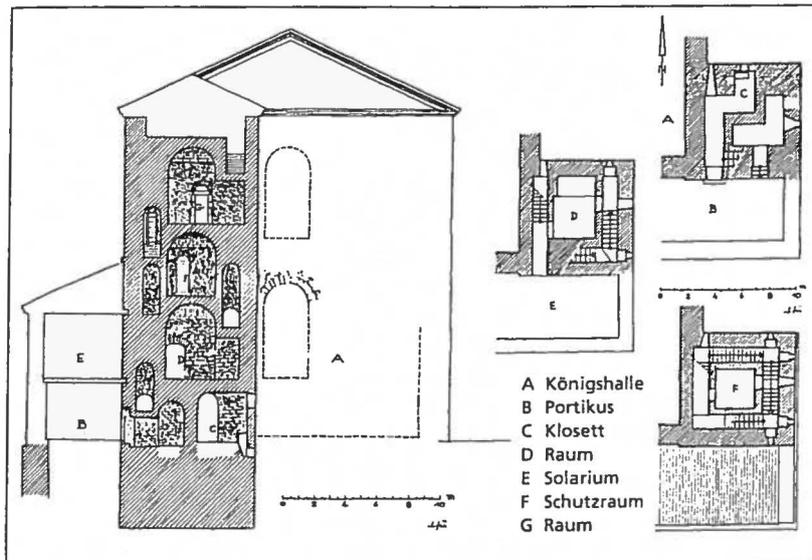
Aachen. Granusturm an der Königshalle, Schnitt und Grundrisse.
